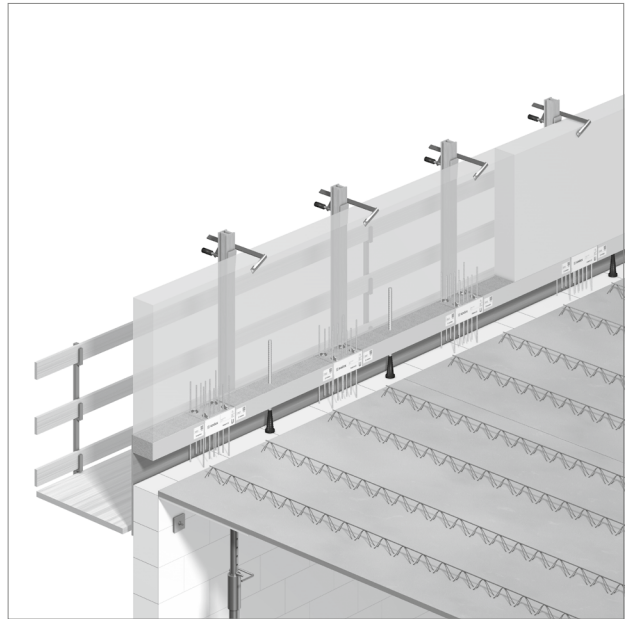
Schöck Isokorb® CXT Typ A mit Combar® Fertigteil-Montagestütze: Fixieren der ausgerichteten Fertigteilattika
